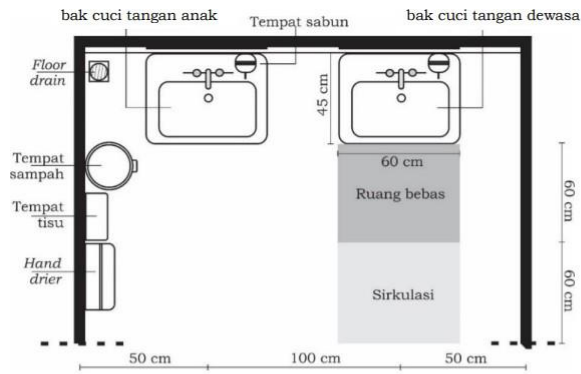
Dimensi minimal ruang dalam toilet penyandang disabilitas
